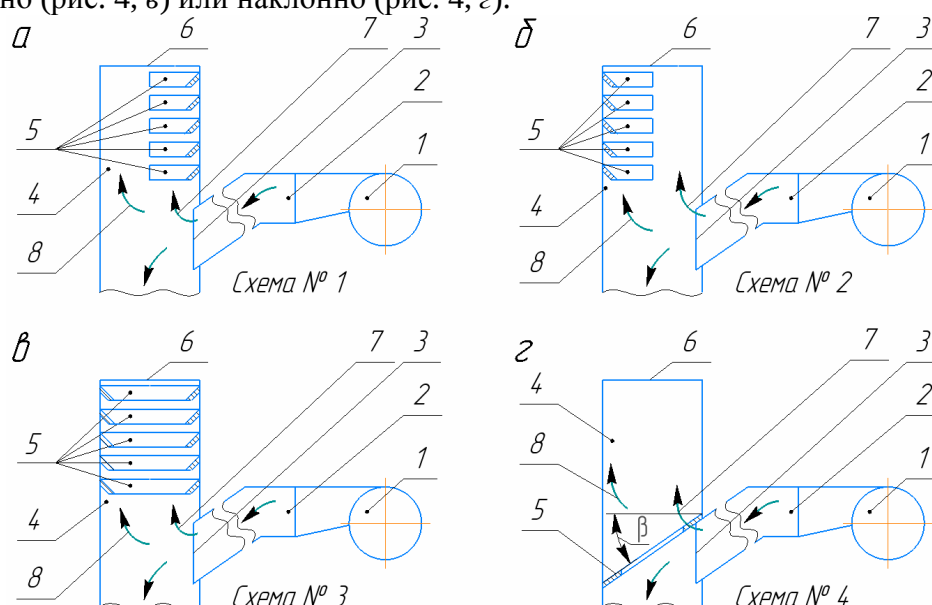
Схемы размещения направляющих пластин для снижения поверхностных утечек воздуха при нагнетательном способе искусственного проветривания: 1 – главная вентиляторная установка; 2 – вентиляционный канал; 3 – вентиляционное окно; 4 – вертикальный ствол; 5 – направляющие пластины; 6 – изготовленная на 3D-принтере цилиндрическая вставка в устье ствола с профилированной внутренней поверхностью; 7 и 8 – линии короткого и длинного тока рабочей жидкости
